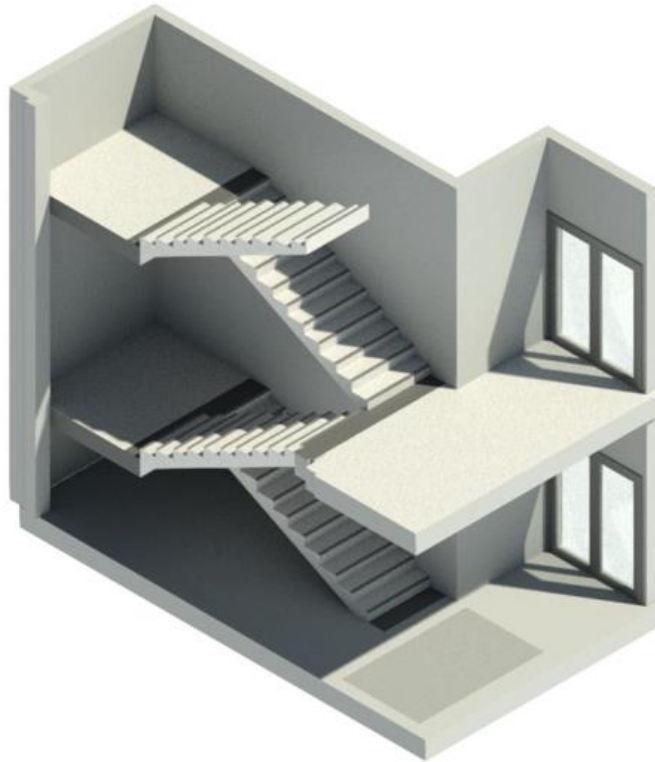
Rysunek z wariantami przykładowego oznaczenia schodów wewnętrznych
